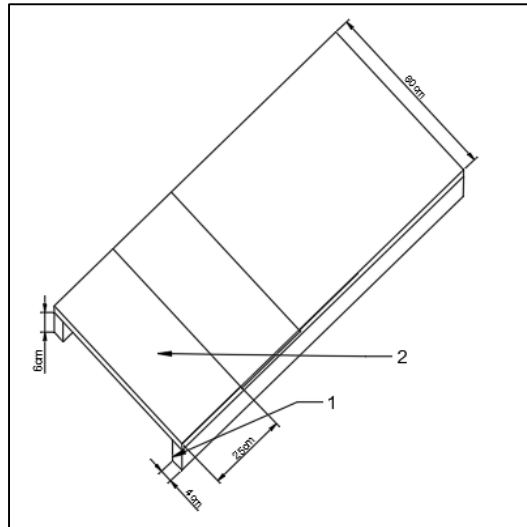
Detalle de encofrado para la losa de entrepiso
